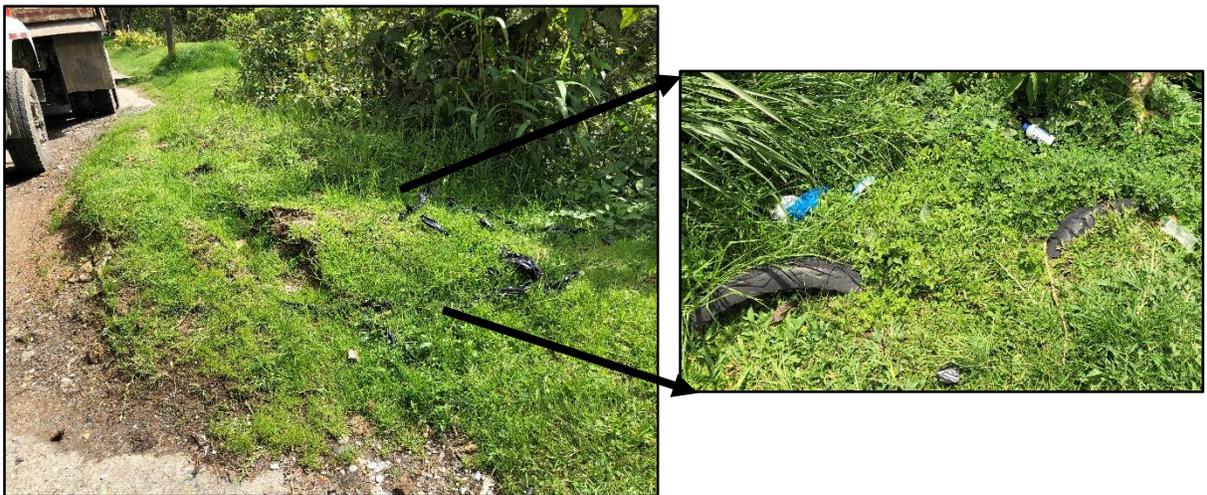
Grietas de tensión y basuras en la zona de estudio. Fuente: elaboración propia.
